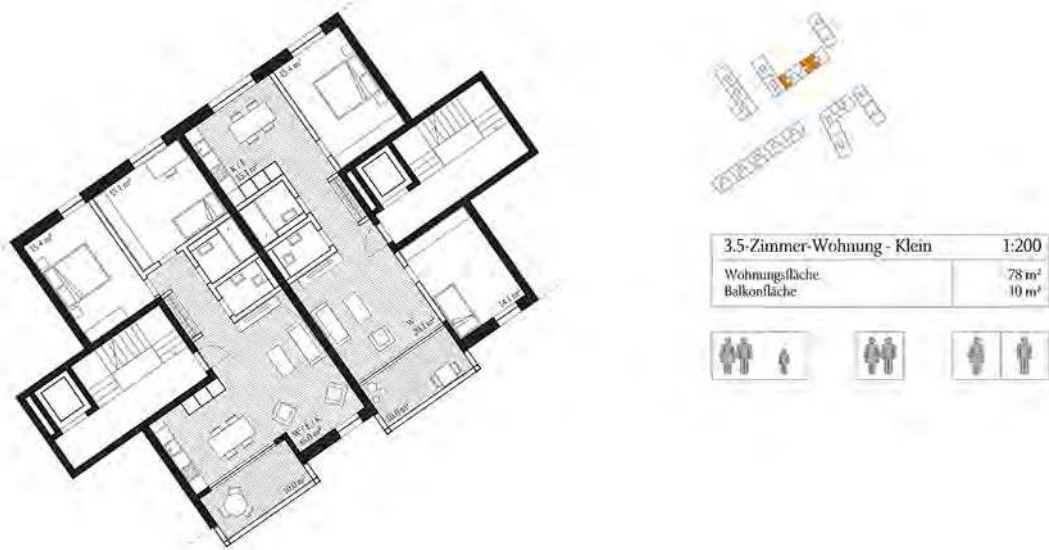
Borough: Wohnungsgrundriss 3.5-Zimmer-Whg.
